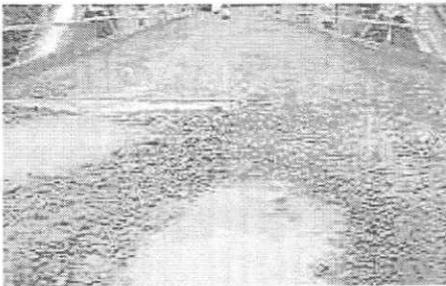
Empozamiento de agua y deterioro del terraplén. Puente la Playa (Chocó).
